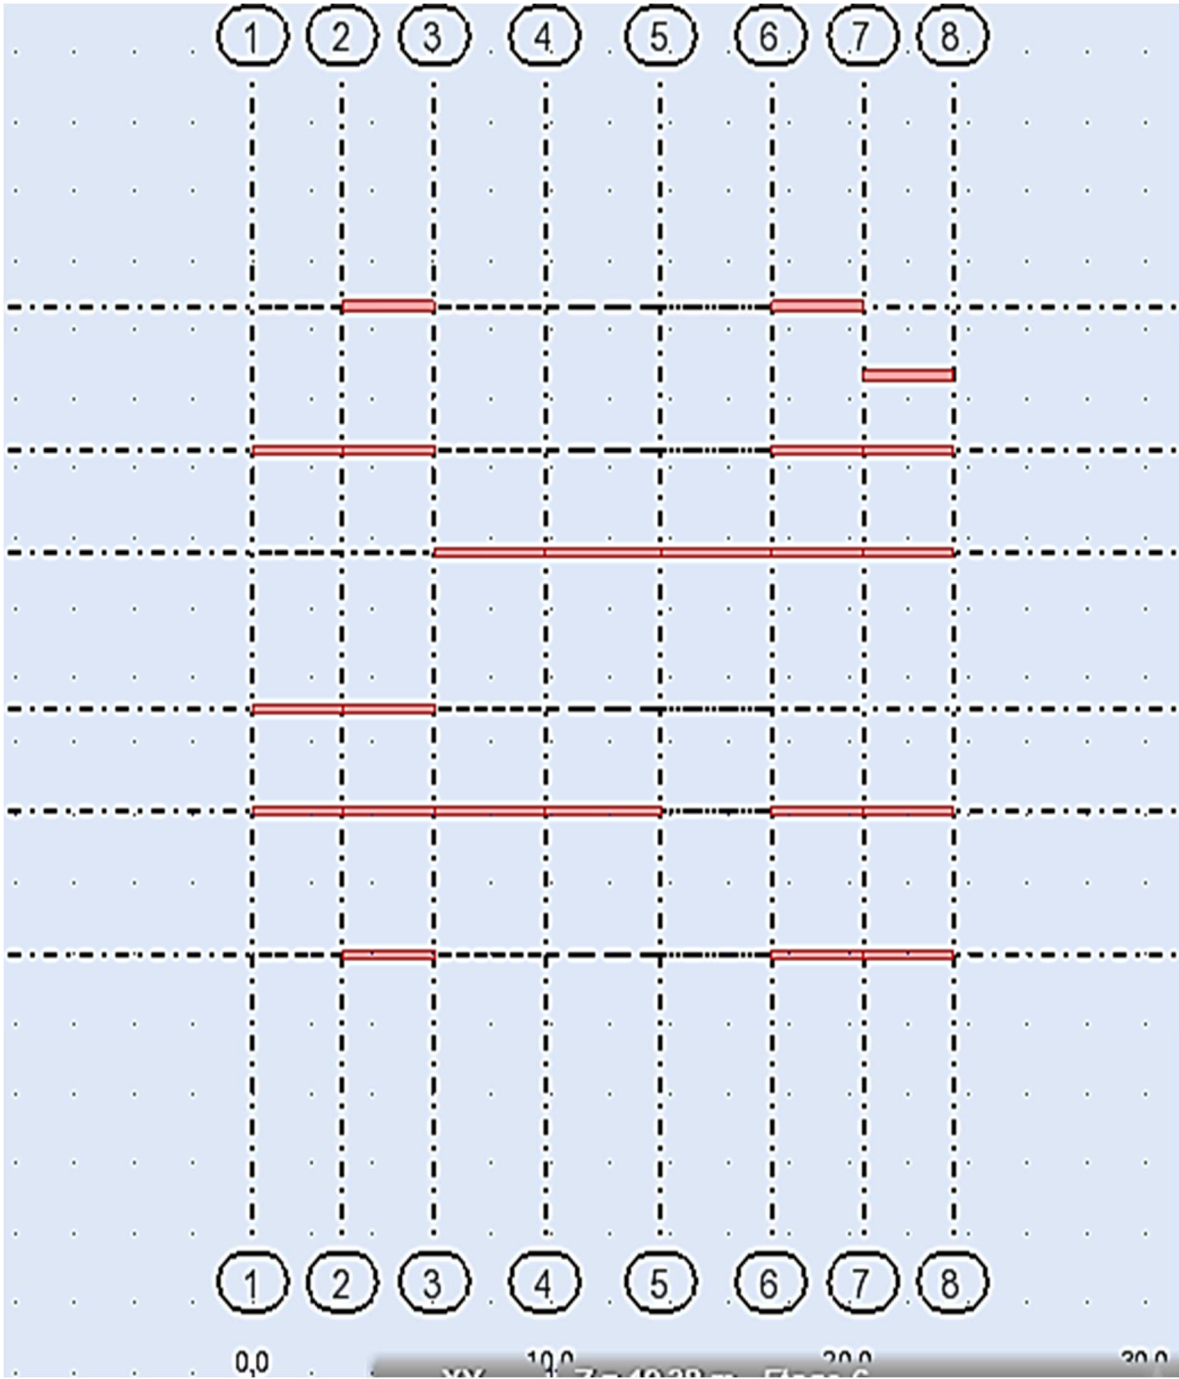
Représentation des poutres secondaires adhérees aux voiles au niveau des structures
